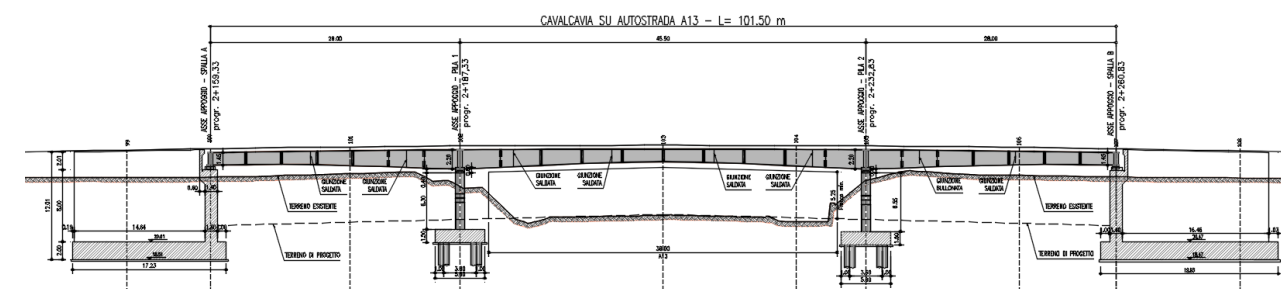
Sezione tipologica di cavalcavia su autostrada
